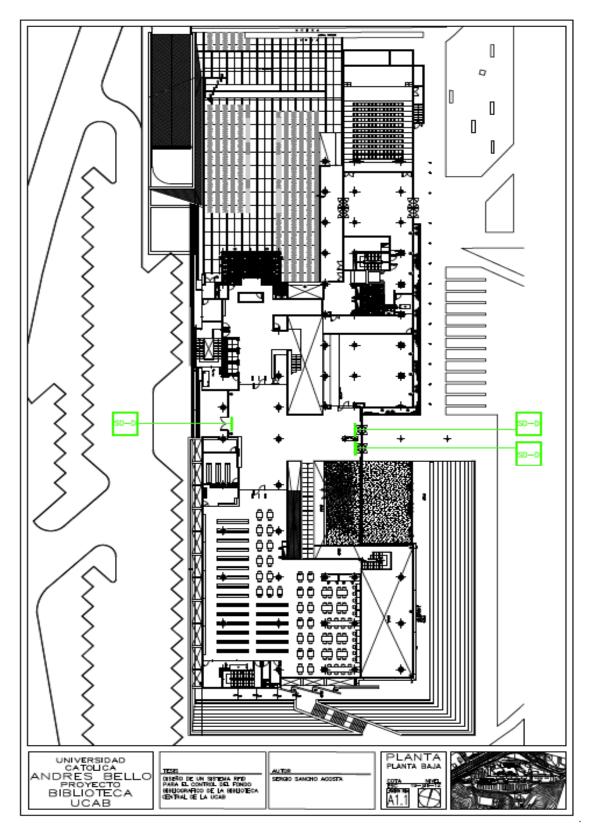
Planos de Planta baja elaborado en AUTOCAD, con señalación de los sistemas de detección. Fuente: Elaboración propia (2012).
